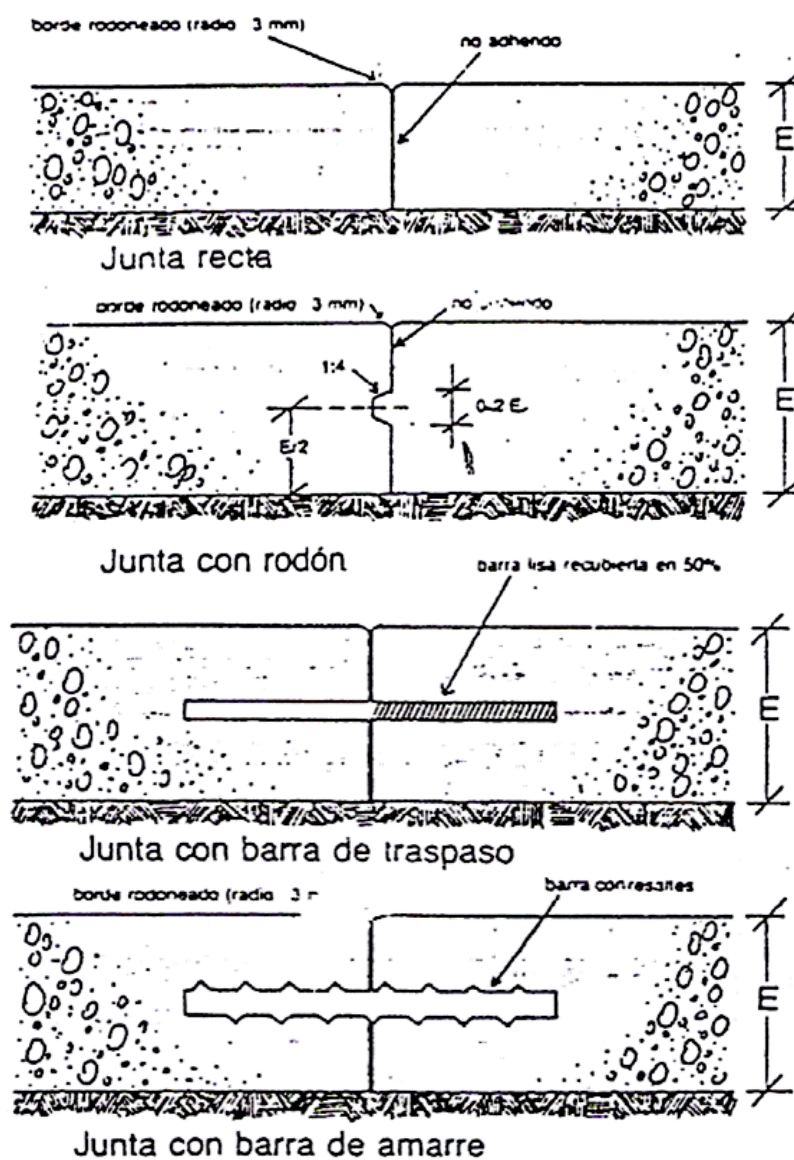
Juntas de construcción, con barra de traspaso y con barra de amarre
